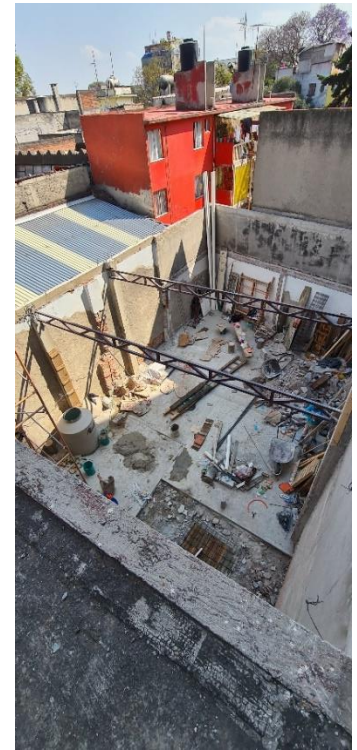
Vista panorámica de área de futura bodega. Autoría propia.
